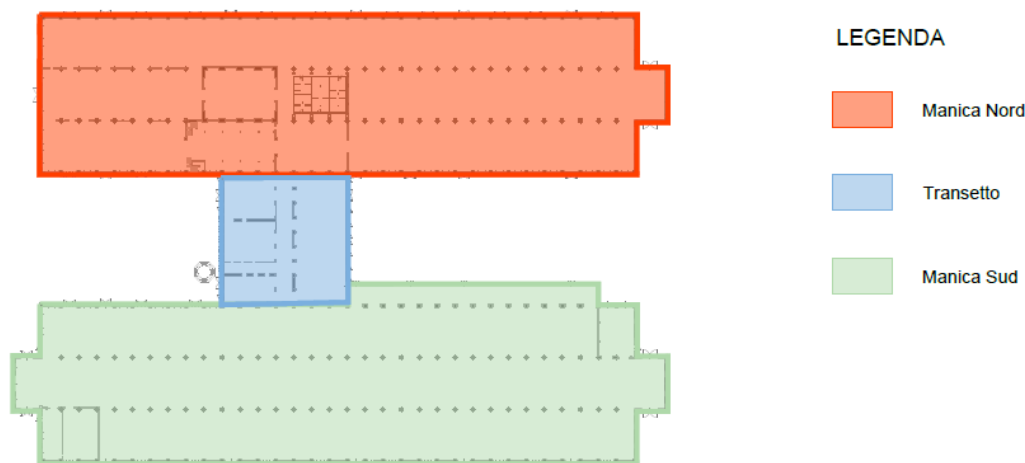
Pianta OGR fornita su gentile concessione da FOR Engineering Architecture ed elaborata dalla sottoscritta.
